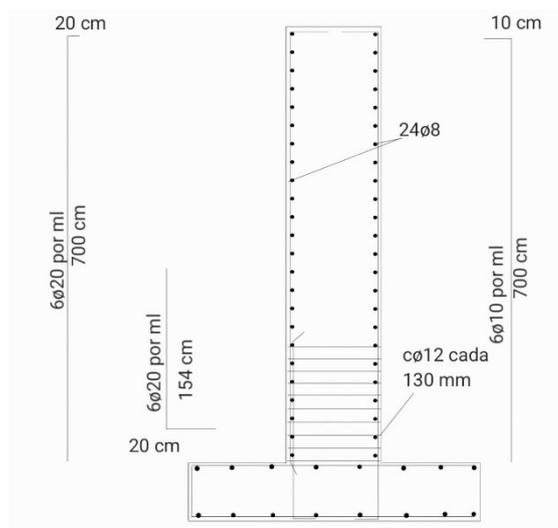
Disposición del armado para un muro de siete metros y canto constante (Fuente propia)
